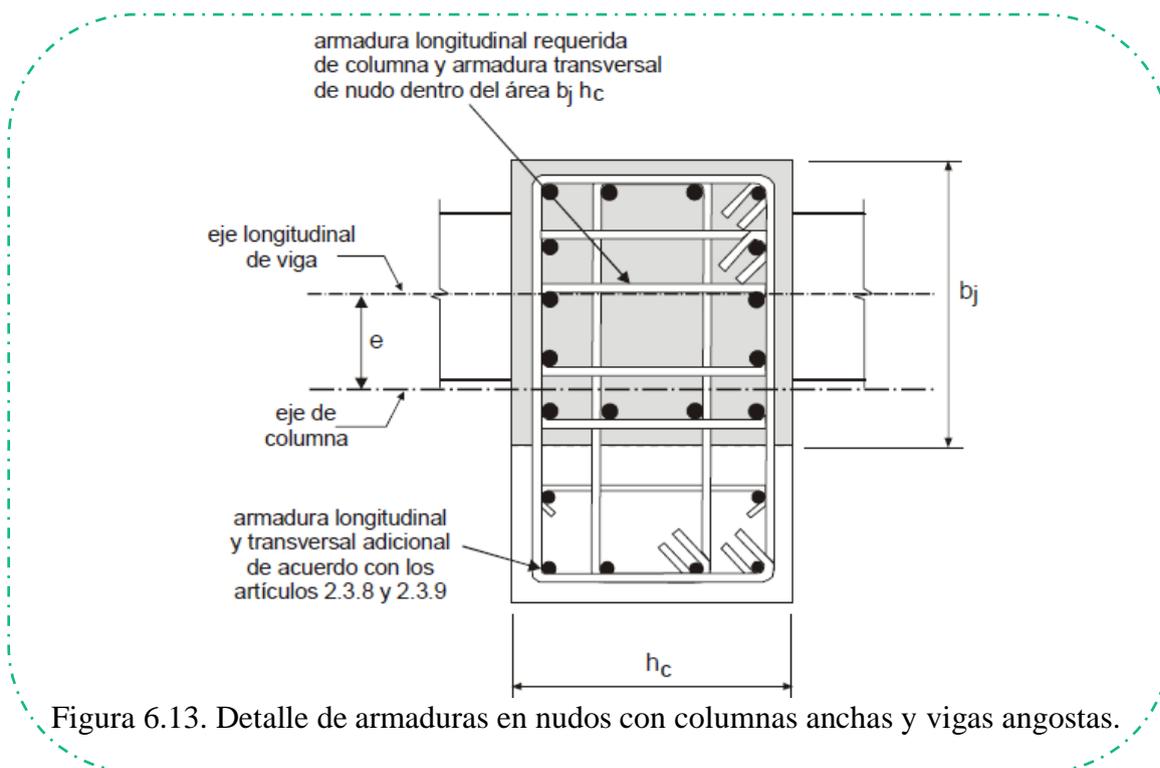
Detalle de armaduras en nudos con columnas anchas y vigas angostas.
